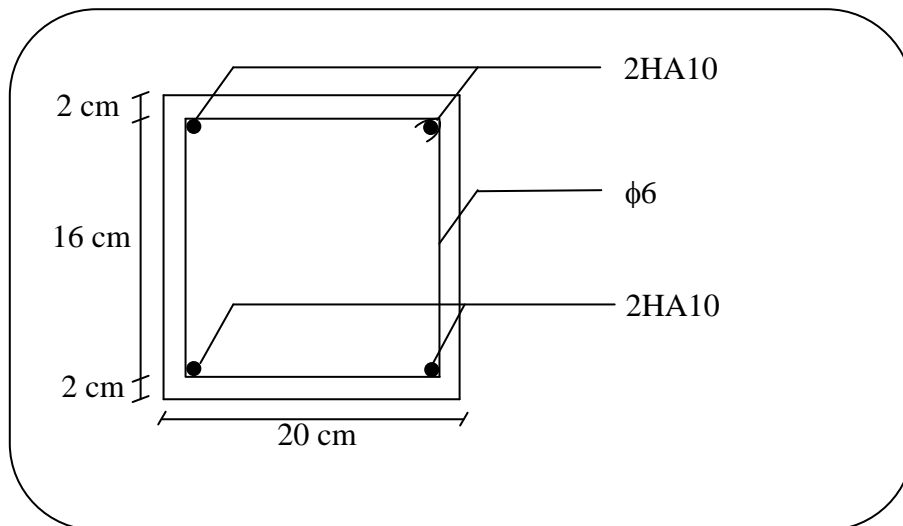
Schéma de ferrailage du chaînage vertical
